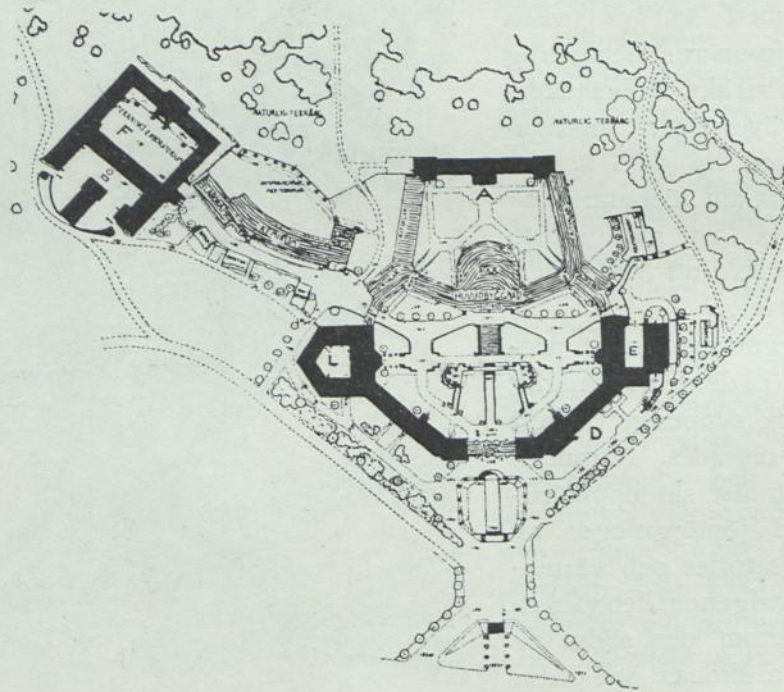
TREDJE PRIS: SITUATIONSPLAN.
